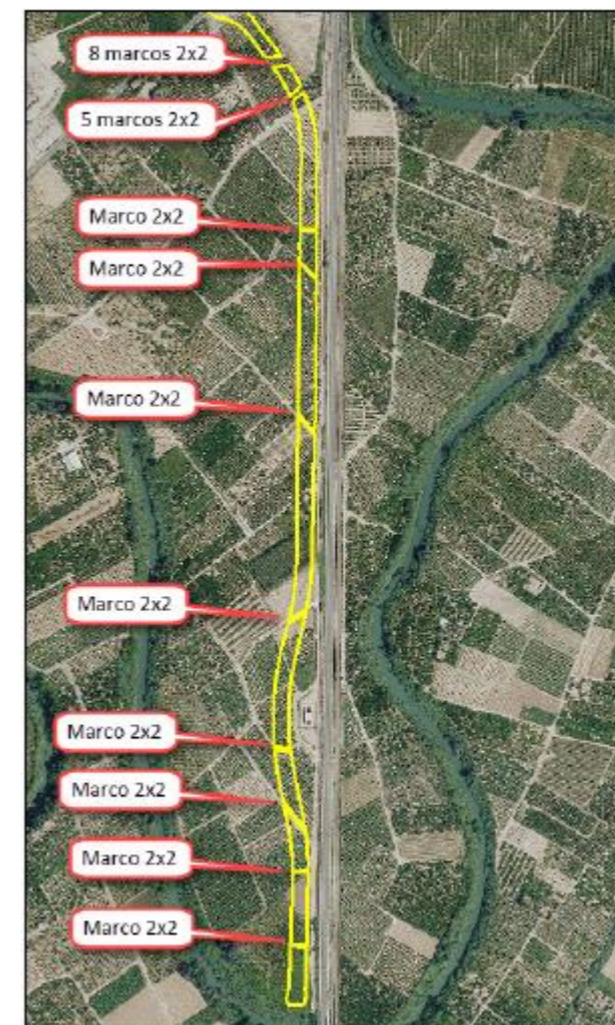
Obras de drenaje transversal previstas. Tramo Centro
